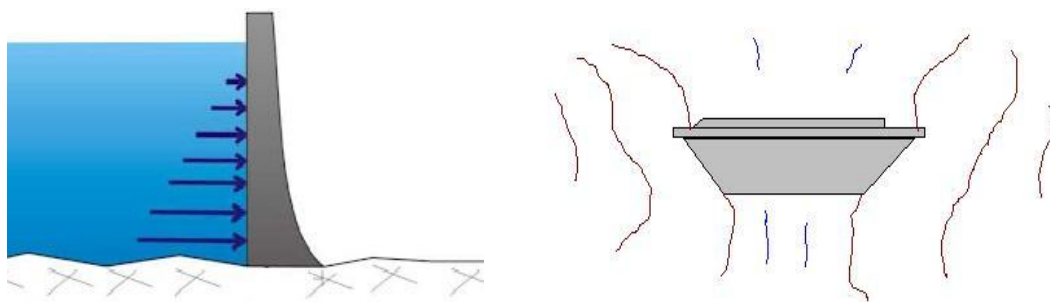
Barragem de gravidade. Perfil típico e vista em planta.
